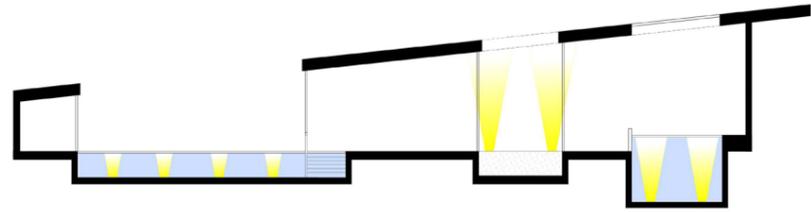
Schnitt Badehalle - Kunstlichtsystem Becken und Atrien
